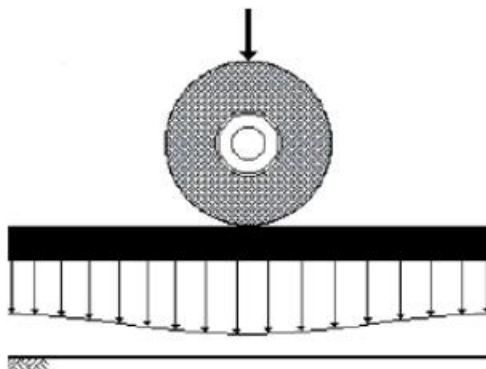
Distribuição da carga sobre o pavimento rígido (Cintra, 2012)
